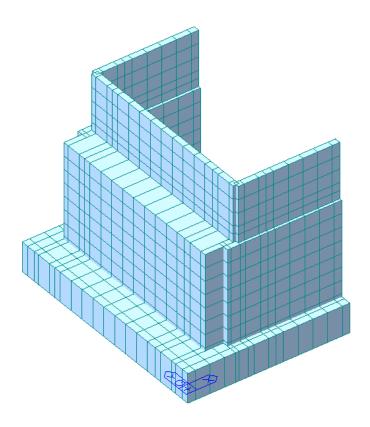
Vista 3D estrusa del modello di calcolo Spalle
